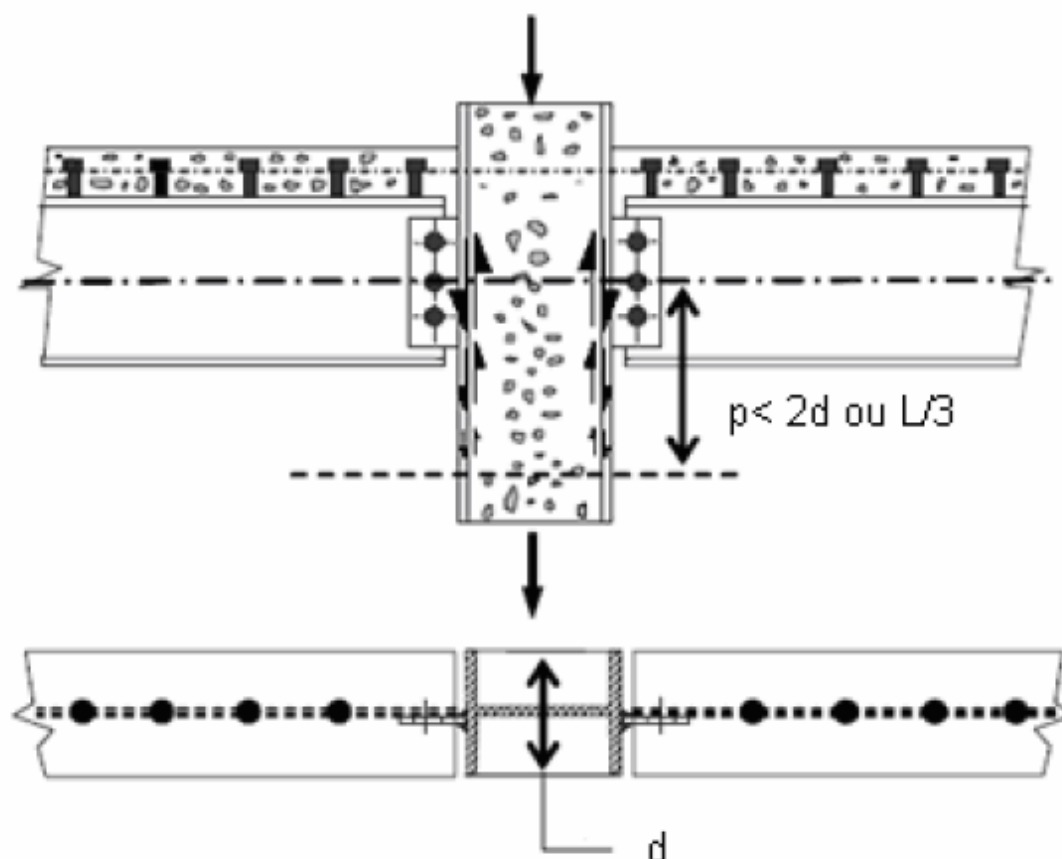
Transferência de forças numa união mista viga-pilar [5]
